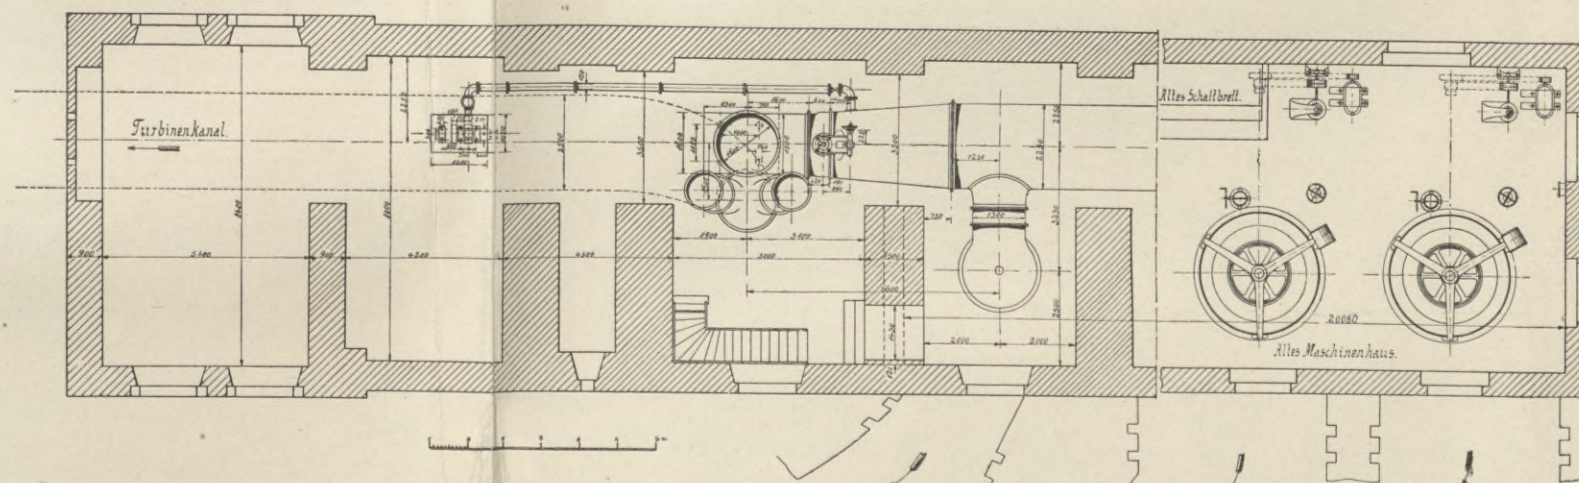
Grundriss des alten Krafthauses im Turbinenraum. 1 : 266.
